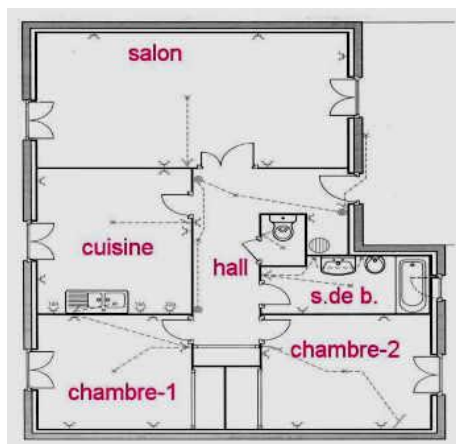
6 Un Schéma architecturaux [1-2-12-15]
